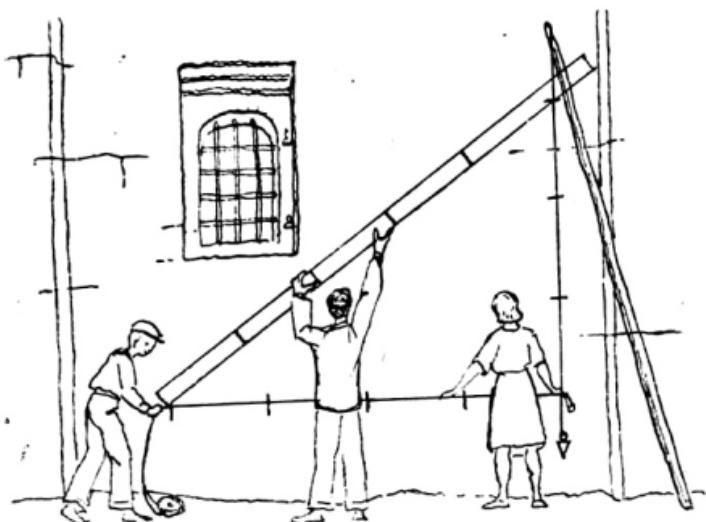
Проведение нулевой линии на стене здания с помощью отвеса
